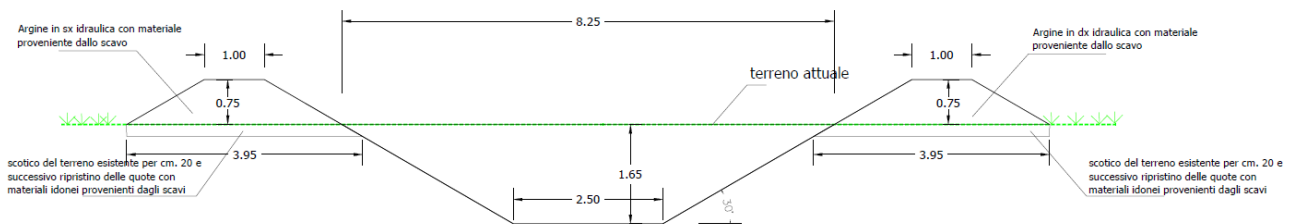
Sezione tipo - Canale a valle del 4 attraversamento
